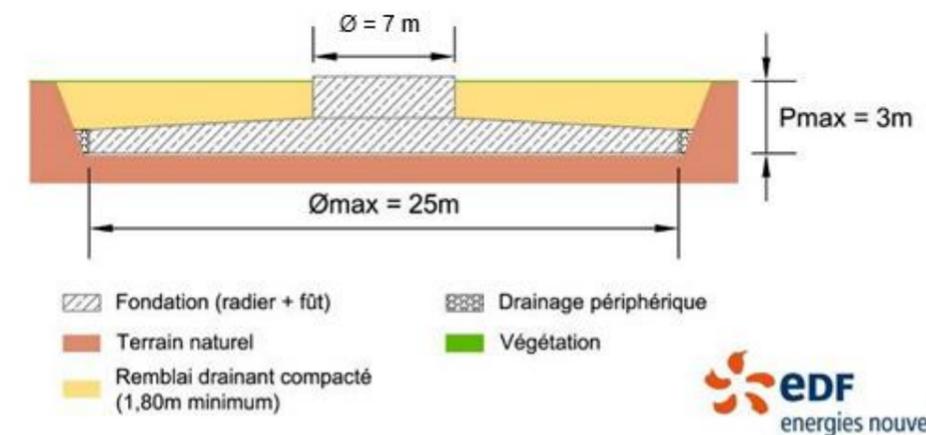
Principe de dimensionnement d'une fondation d'une éolienne
